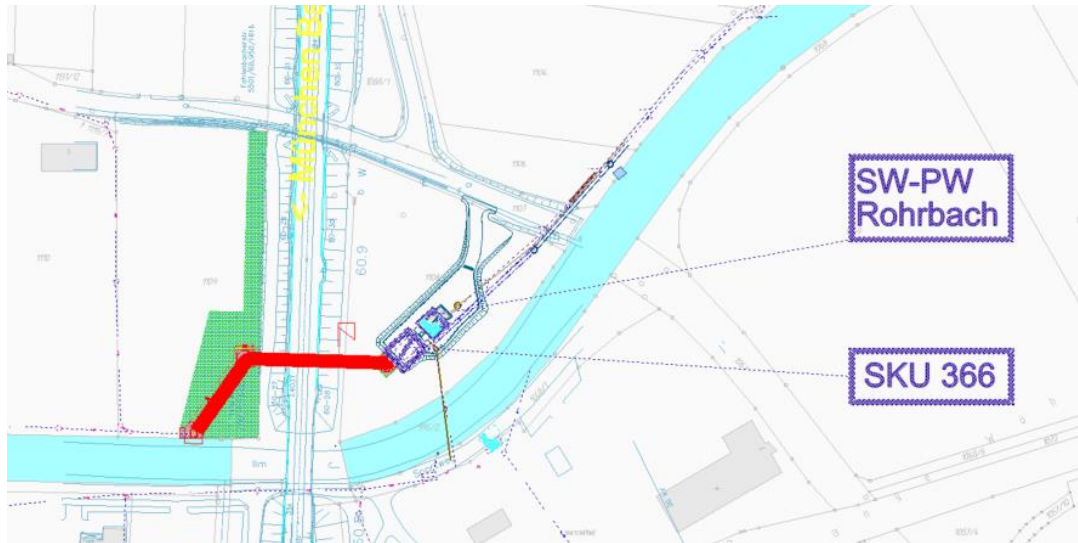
ausstehende Baumaßnahme am SKU 364; Planung rot (zukünftig SKU 366)
